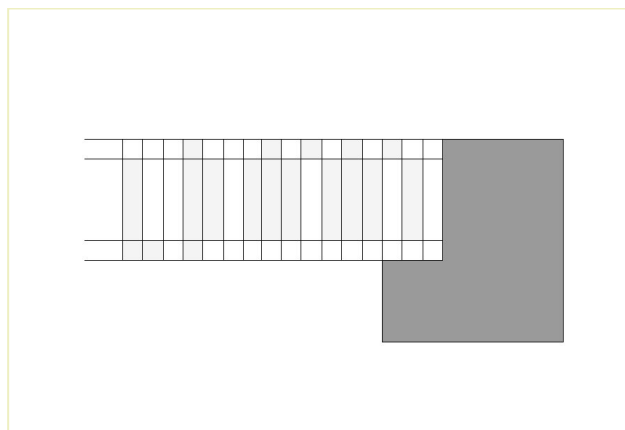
ESQUEMA DE VIGAS EN T Y LOSA
